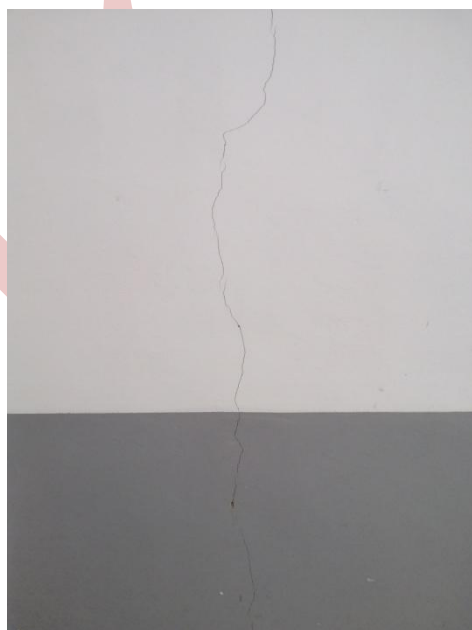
,100,101 et 102 : Apparition des fissurations au niveau des enduits.
